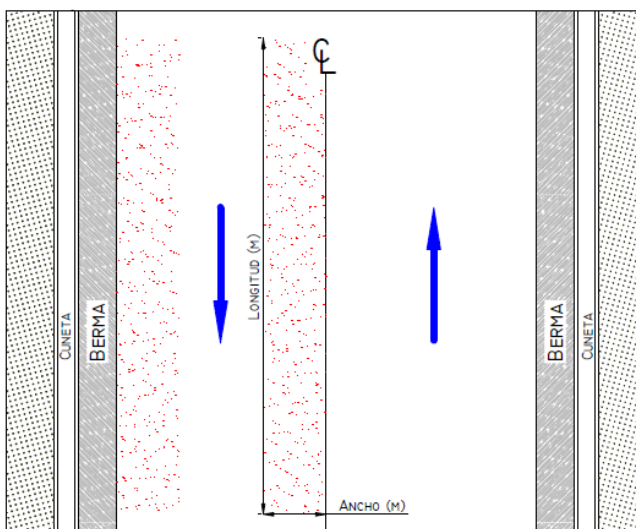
Desgaste superficial sobre pavimento asfáltico existente.
